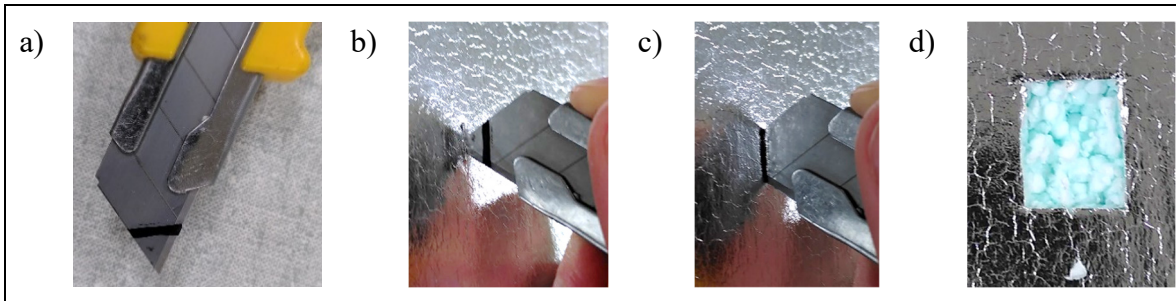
a) marquage de la profondeur souhaitée sur le cutter ; b) positionnement du cutter sur la surface à découper ; c) découpe à la profondeur souhaitée ; d) petit carré découpé à répliquer sur toute la surface à creuser
